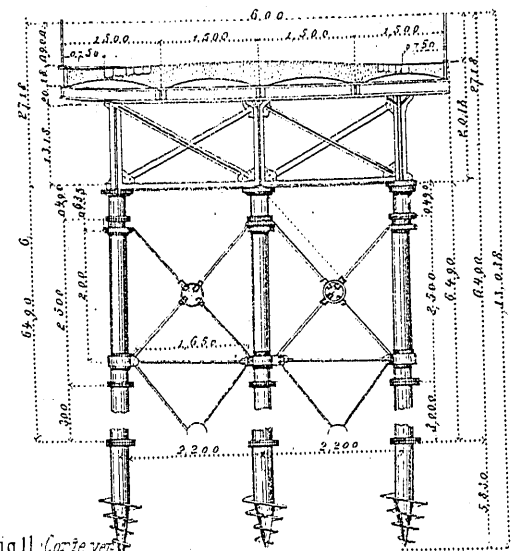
Viga de grilla Viga transversal-pilotes del pilar y bancafilia
